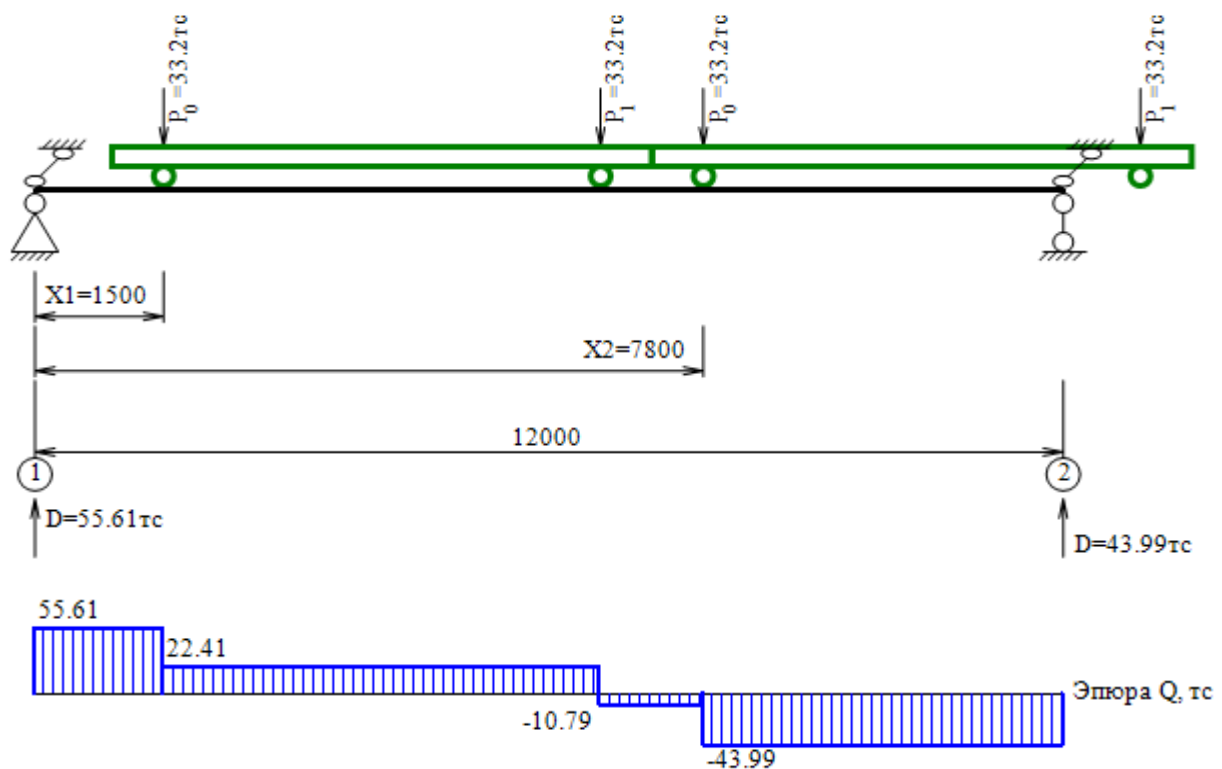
Эпюра усилий Q от вертикальной нагрузки при расчетном положении кранов
